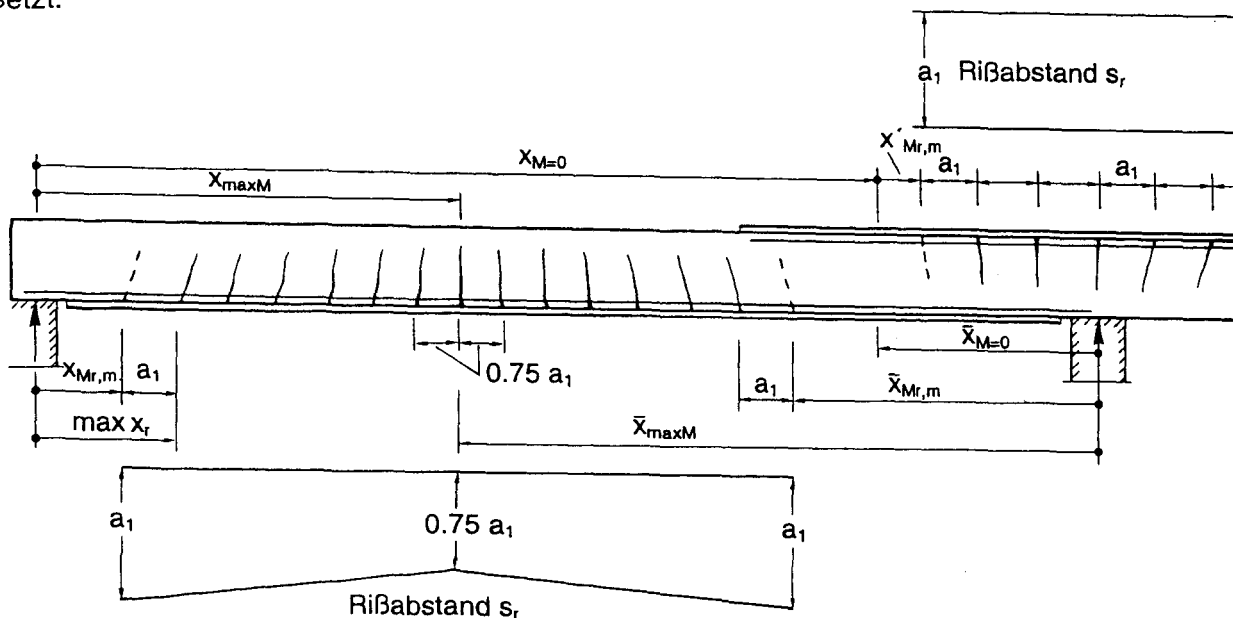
Rechnerisches Endrißbild eines mit CFK-Lamellen verstärkten Stahlbeton-Durchlaufträgers
